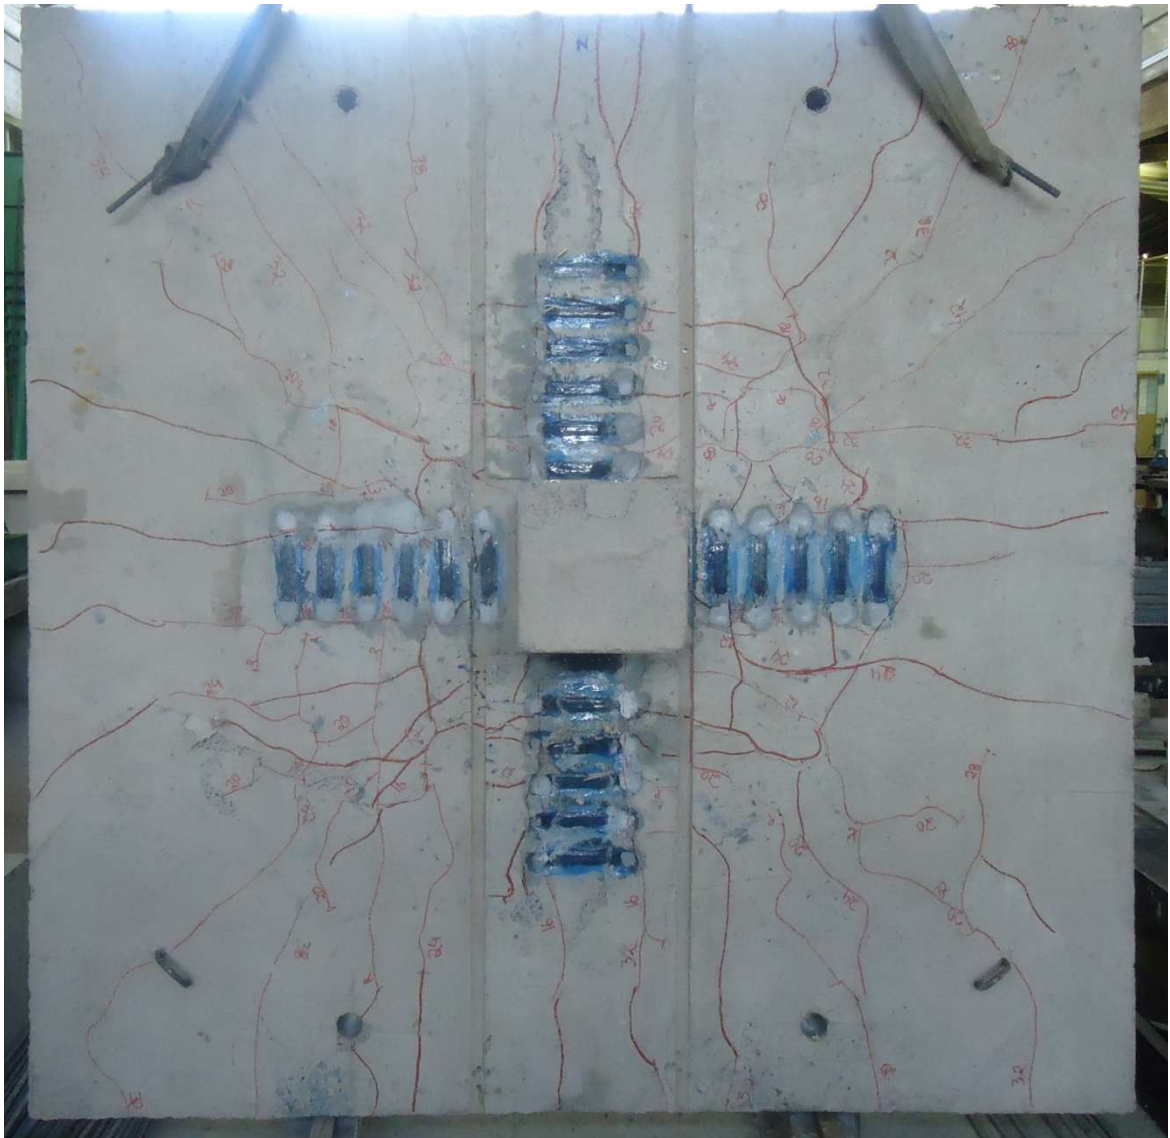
Padrão de fissuração do modelo LC-S1
